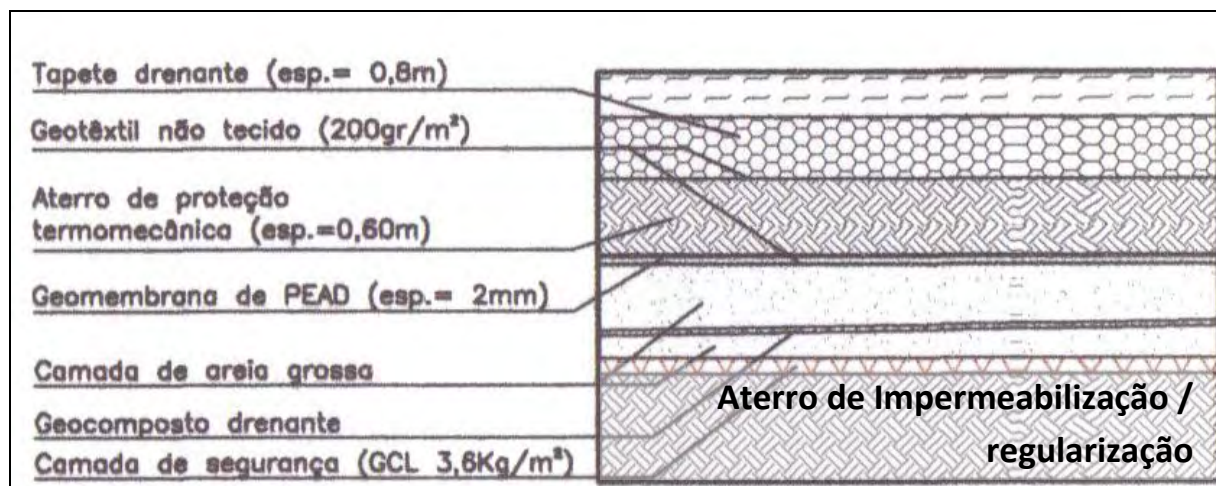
Detalhe das camadas de impermeabilização da base das células e dreno de testemunho (sem escala).
